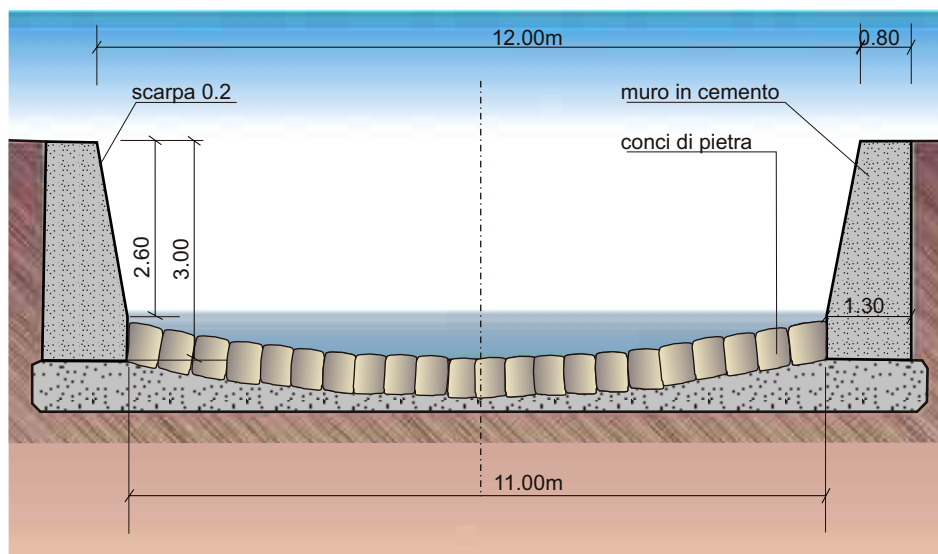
Nello schema a fianco è raffigurato un cunettone con muri di sponda e fondo in calcestruzzo rivestiti in pietrame. Il pietrame oltre a migliorare l'impatto visivo dell'opera ha la funzione di proteggere il calcestruzzo dall'abrasione e dagli urti dovuti al materiale, anche di grosse dimensioni, in carico alla corrente.
